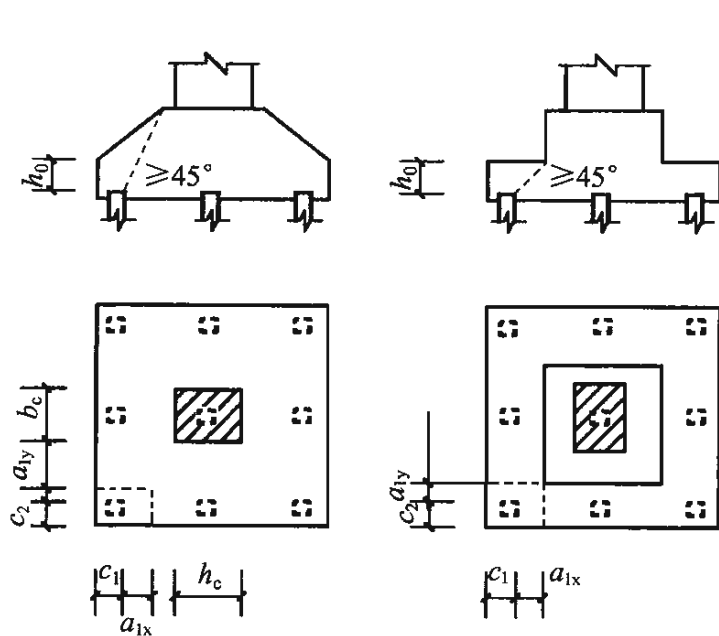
3 矩形承台角桩冲切计算示意图
